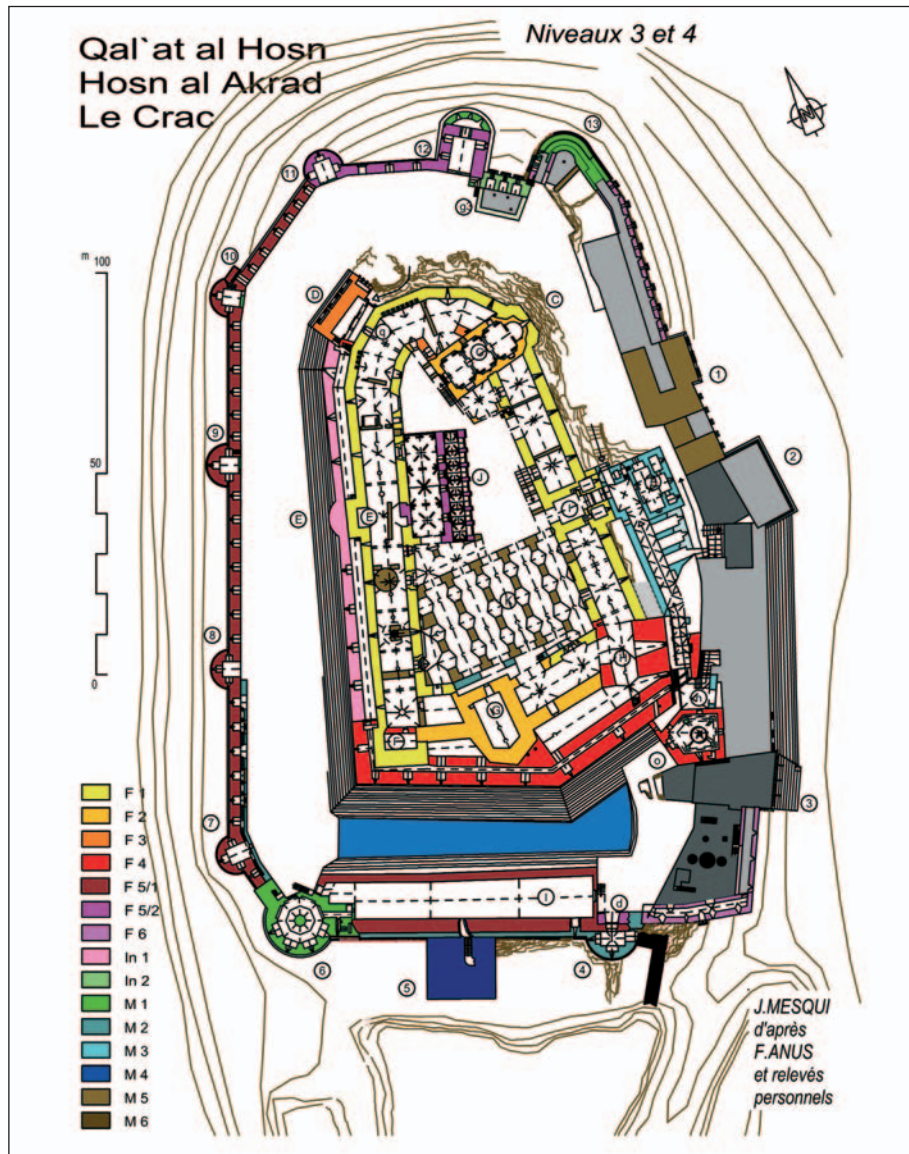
Crac des Chevaliers, plan général (plan d'après Anus et relevés J. Mesqui).
